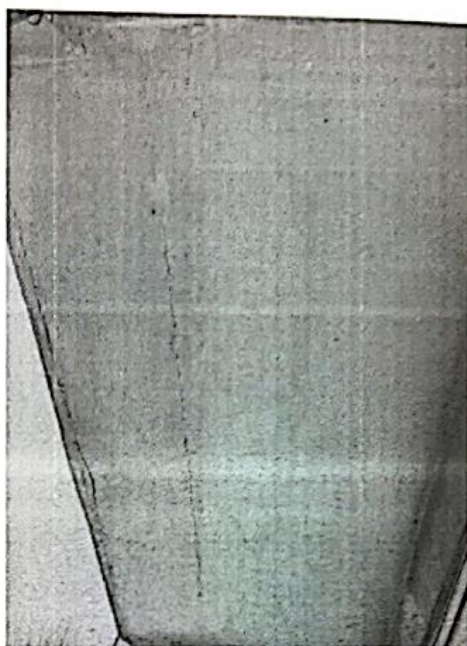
悬挑构件混凝土破损、钢筋锈蚀 3
